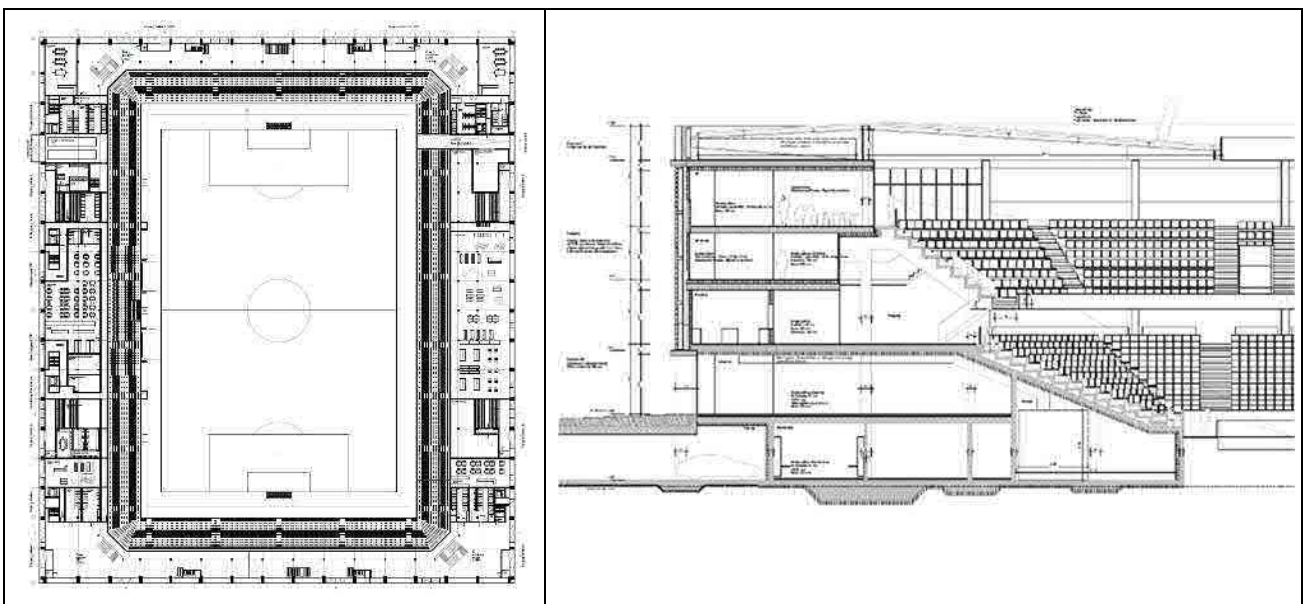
Grundriss und Schnitt Stadion (Stand Richtprojekt, Quelle: pool Architekten)
